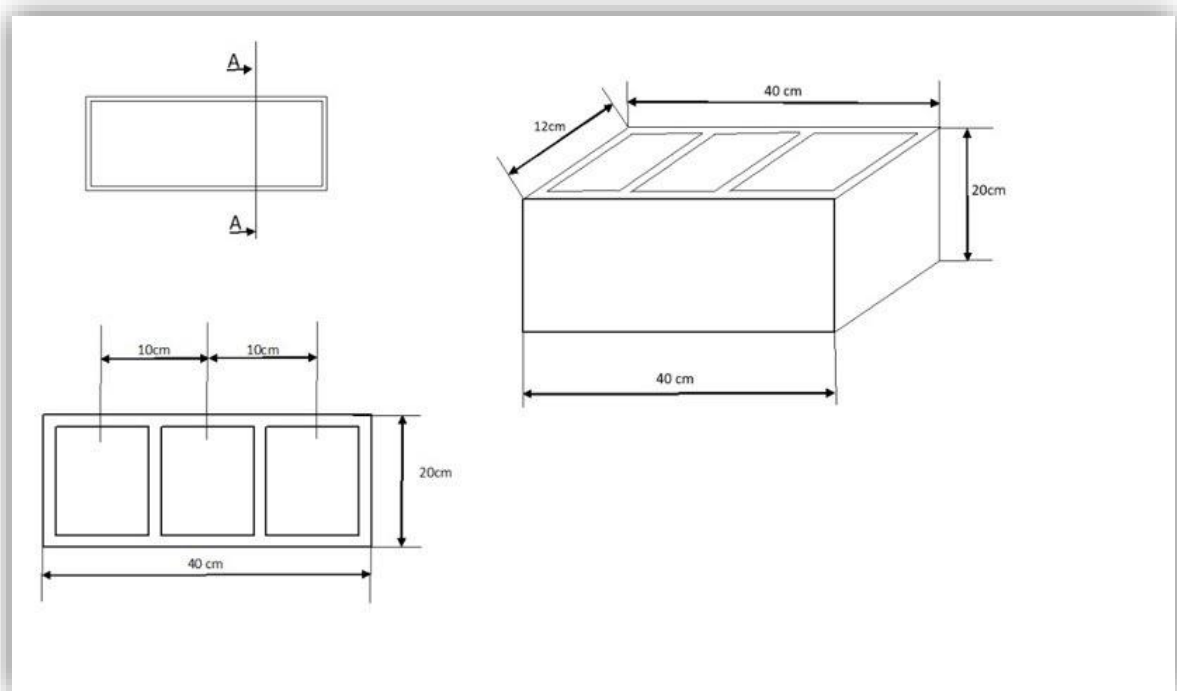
Dimensiones del espécimen bloque de concreto 40x20x12cm
